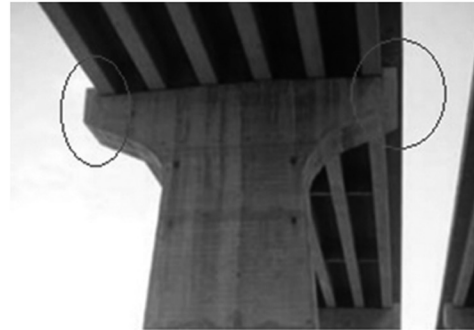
Tope sísmico transversal en un puente de claros simplemente apoyados
